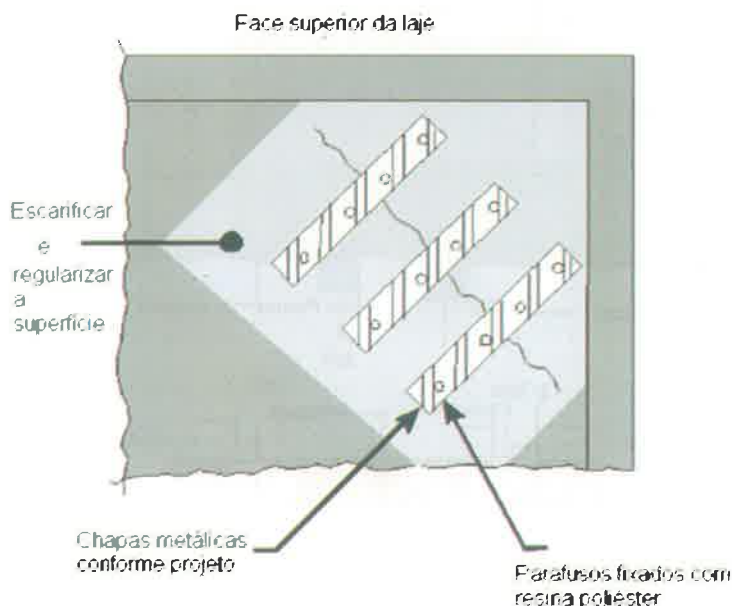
Reforço de momentos volventes em lajes com chapas metálicas aderidas com epóxi.
